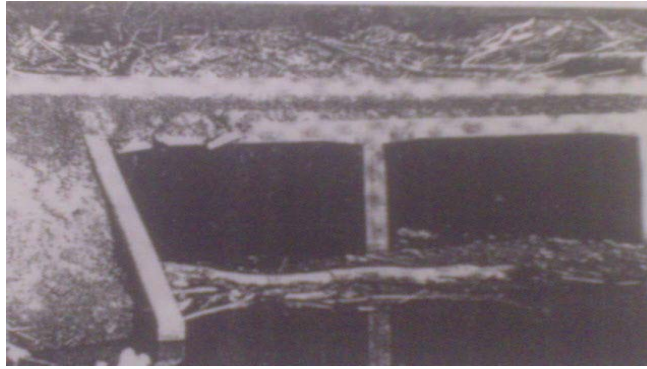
Detalle de los daños de una alcantarilla en Ban Nasan; el terraplén estaban completamente erosionadas
